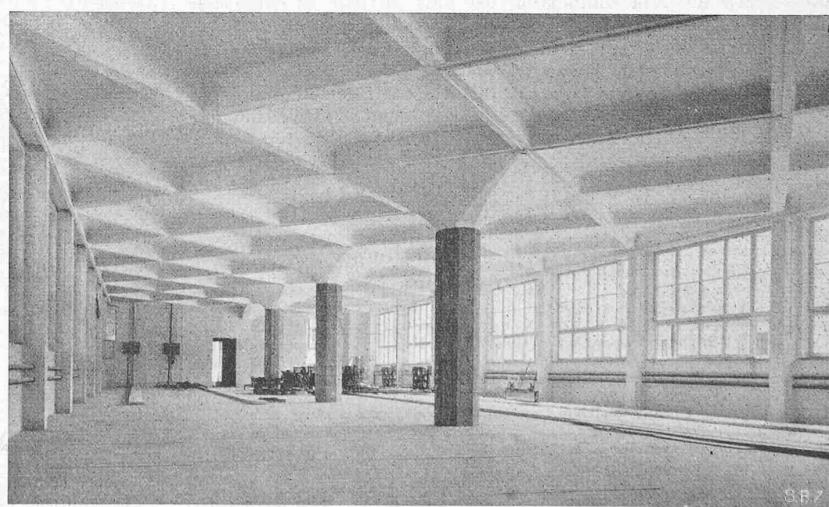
Weberei-Saal im II. Stock des Neubaues Walche in Schaffhausen
